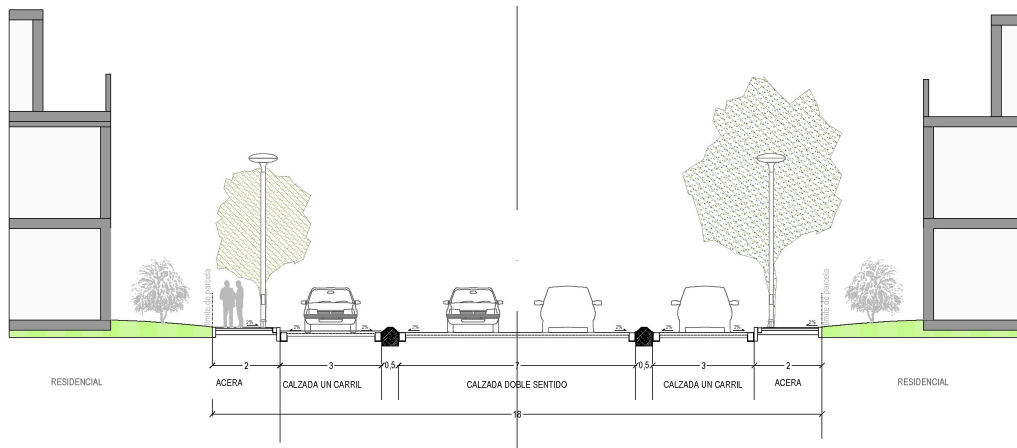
Propuesta para la nueva sección de la carretera M-415
